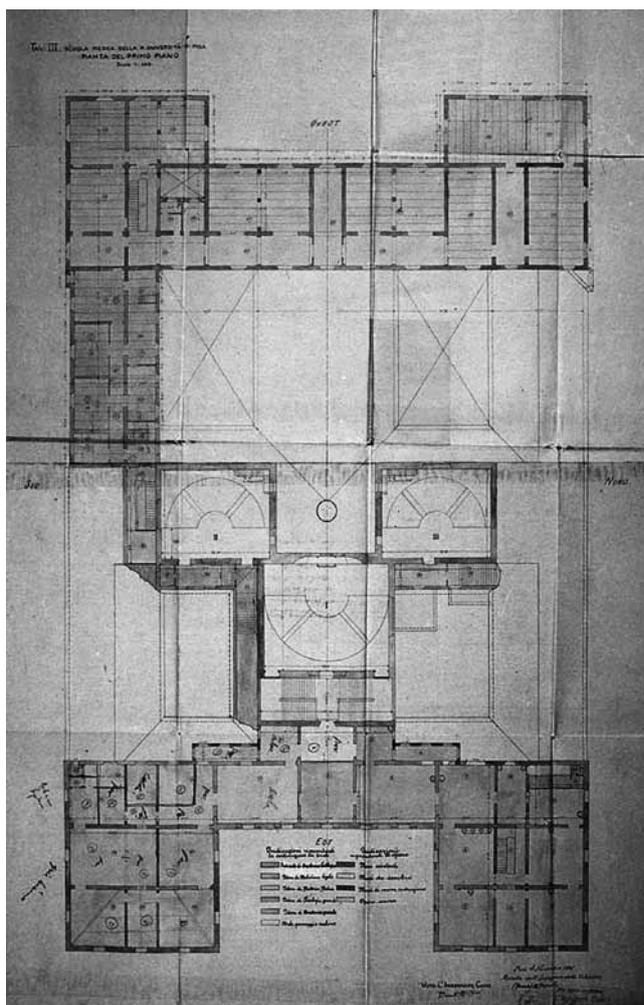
Planimetria del piano ammezzato formato dal rialzamento del corpo delle aule
